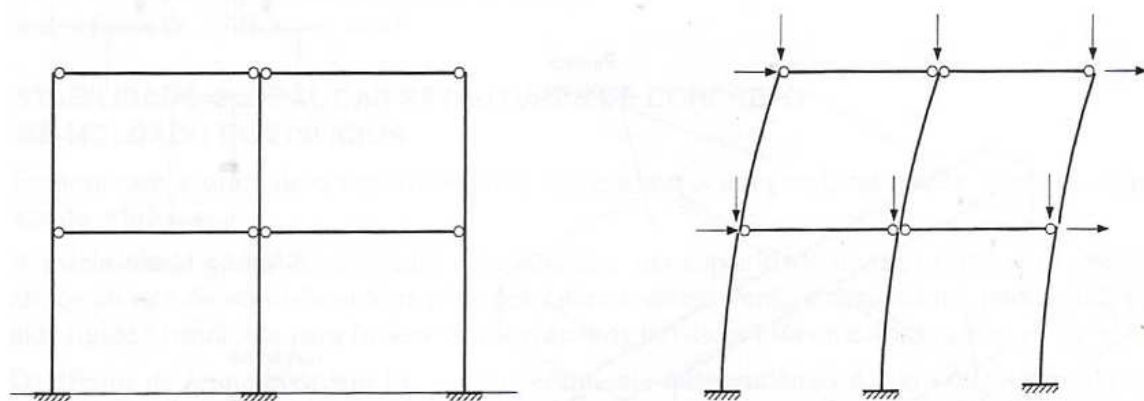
Contraventamento por pilares engastados na base (Fonte: El Debs, 2000).
